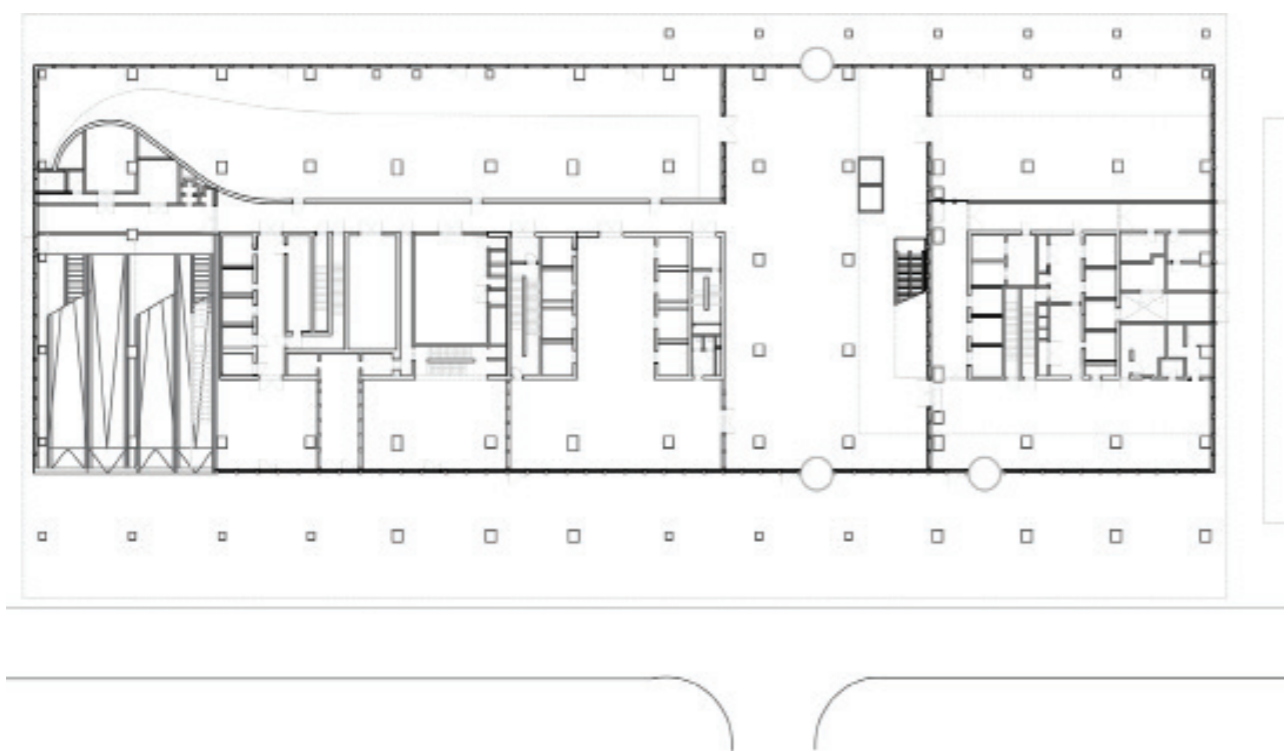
Planta Baja del edificio De Rotterdam, Rotterdams.
